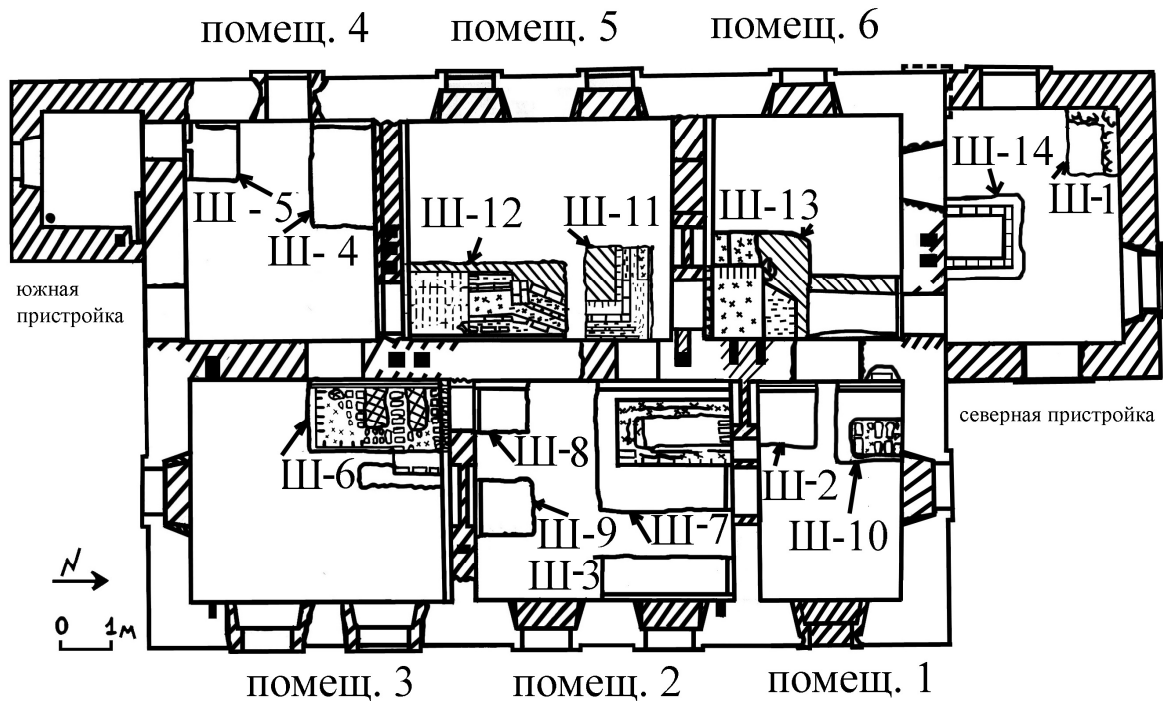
Ситуационный план здания на уровне первого этажа со всеми выявленными под полом конструкциями и шурфами
